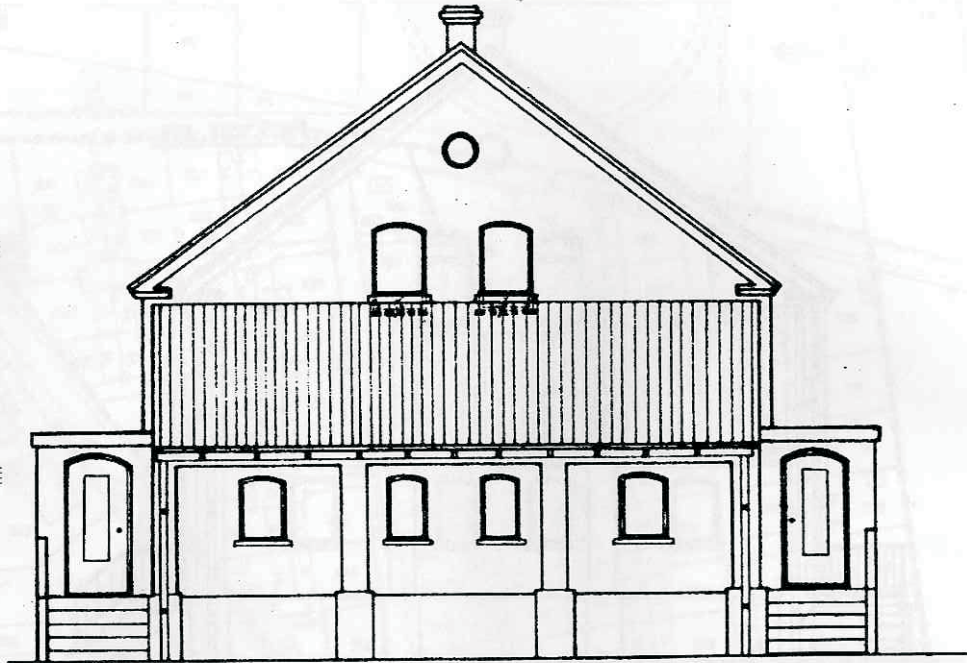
Anbau Giebelseite (b), geschlossener Vorbau (Giebelseite)
